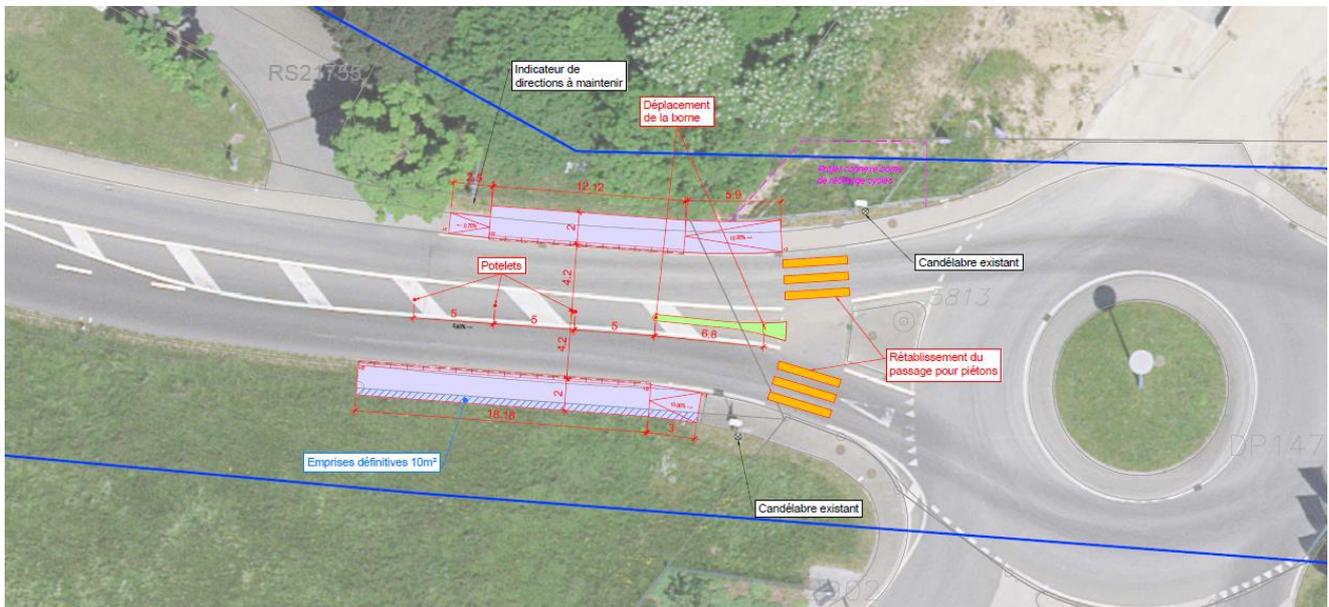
emplacement des deux arrêts (source SITN et plan SD ingénierie)
